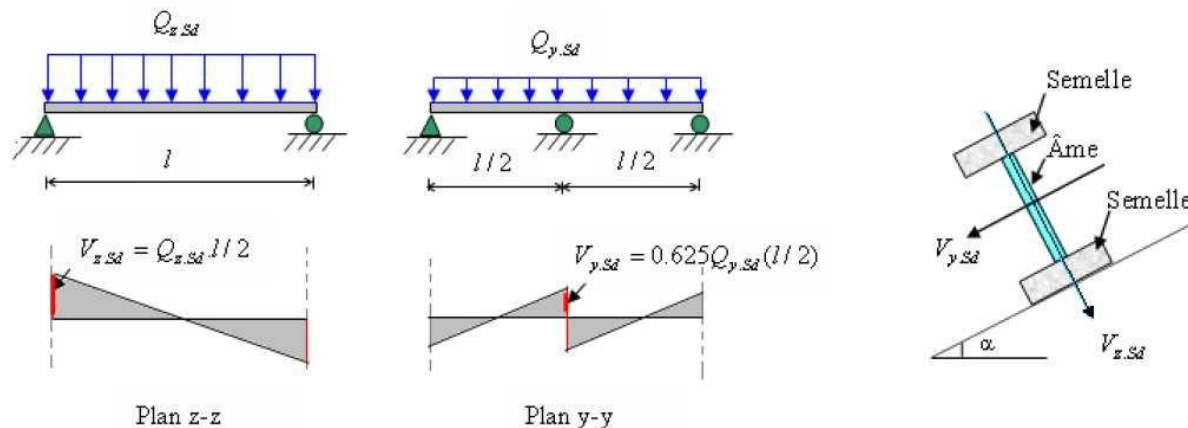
Panne de toiture en cisaillement sous les différents plans de chargement.
